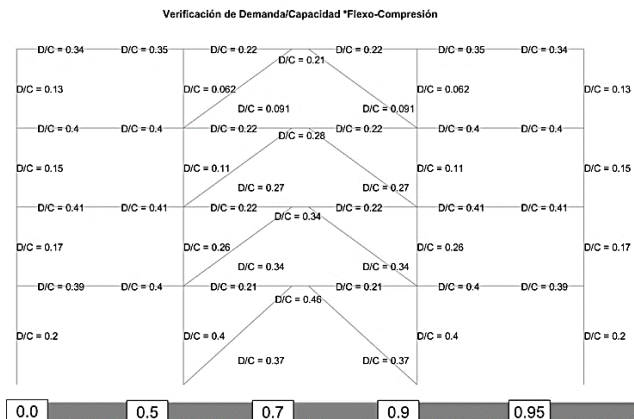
Pórtico de acero modelado mediante CEINCI LAB.
